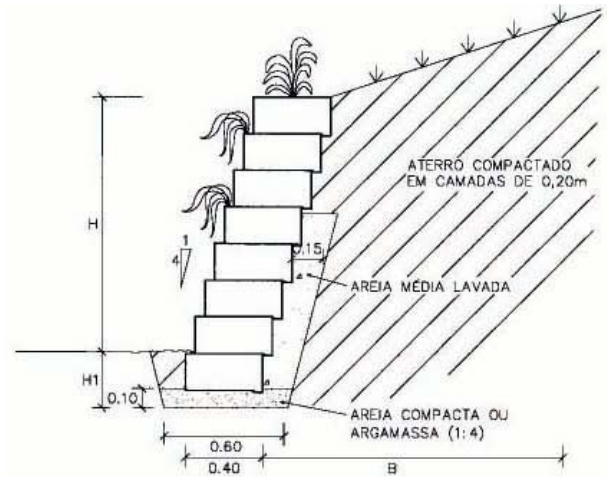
Sección transversal típica de un muro con materiales y detalles constructivos.
